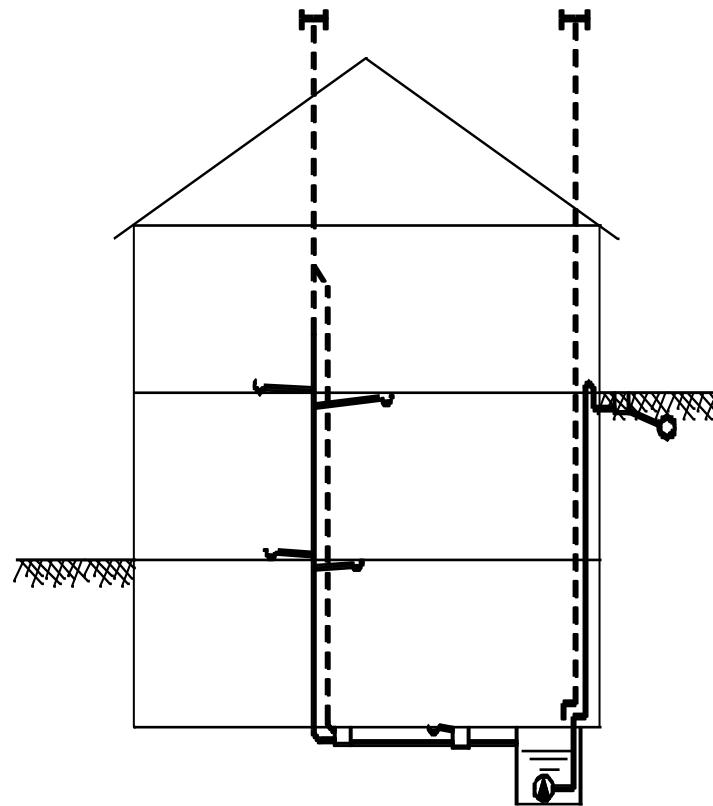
Sistema de drenagem predial com ventilação secundária parcial e com elevação
